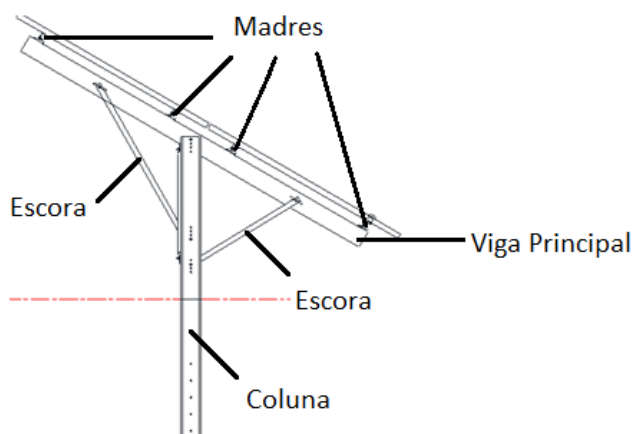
Sistema estrutural do pórtico tipo do parque de painéis fotovoltaicos
